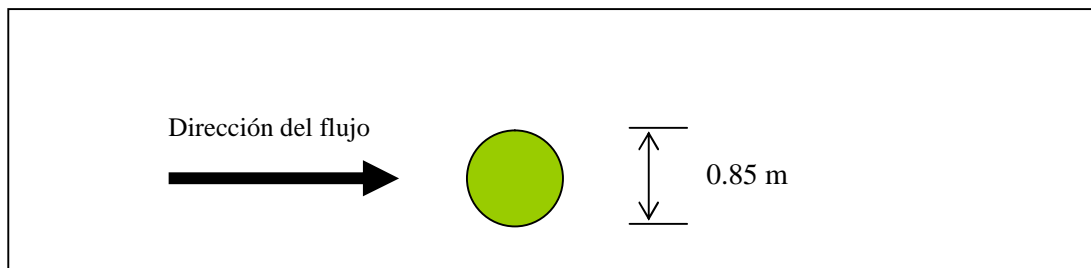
Sección del pilar del Puente Suarez, carretera Paucartambo – Puente El Milagro
